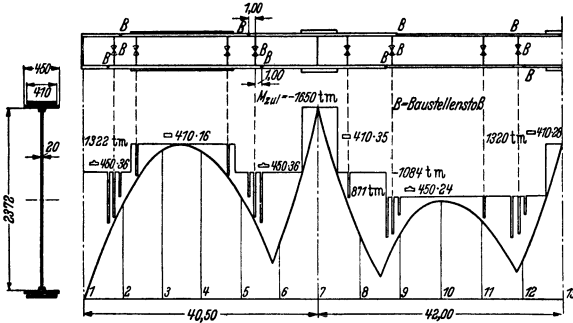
Momentendeckungslinie für einen geschweißten Vollwandbalken. Nach V. HASSELBLAD u. D. FUCHS: Bautechn. 17 (1939) S. 360.
